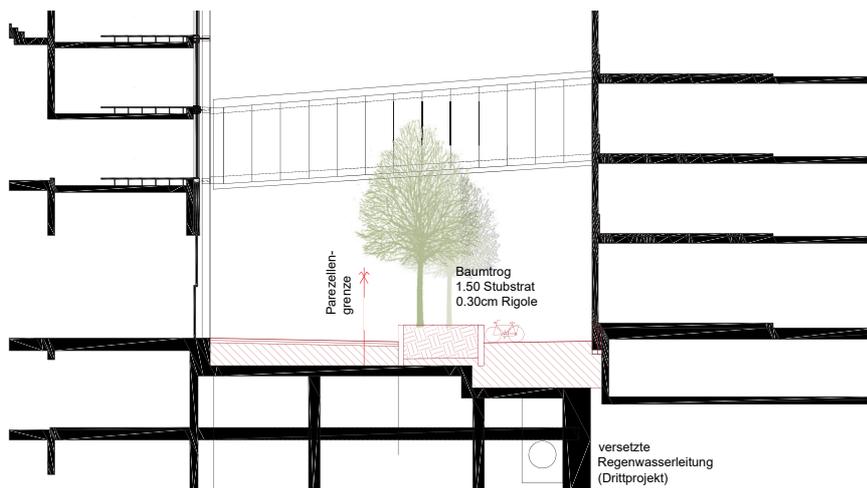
Ausschnitt BGK: Konzept für den Aussenraum südlich Solitär im westlichen Teil (Schemaschnitt Gebäude gemäss Machbarkeitsstudie),
